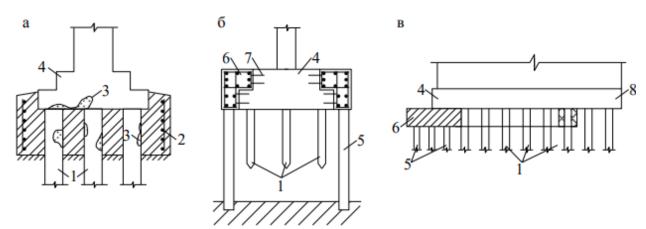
Підсилення пальових фундаментів: а — омонолічуванням оголовків паль; б — влаштуванням виносних паль; в — підведенням додаткових паль; 1 — існуючі палі; 2 — залізобетонна обойма; 3 — пошкодження у палі та ростверку; 4 — ростверк; 5 — додаткова виносна паля; 6 — новий ростверк; 7 — зв'язки додаткового ростверку з тим, що підсилюється; 8 — сторона будівлі, по якій вирубувались палі
